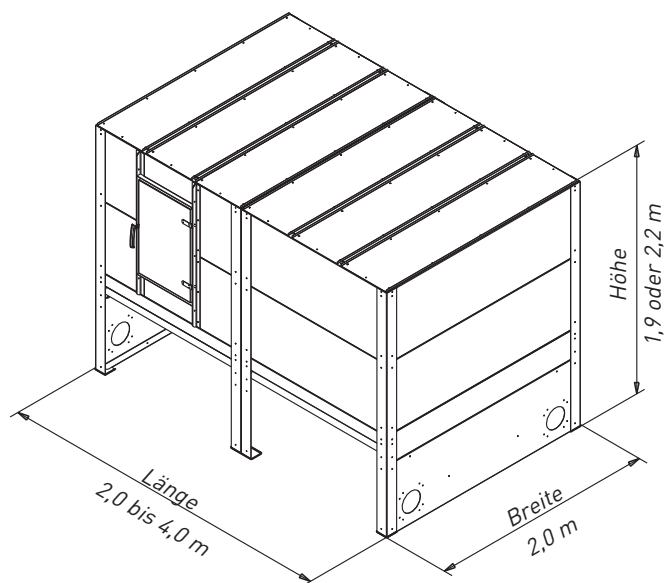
Stahlblech-Tanks mit Breite 2,0 m
